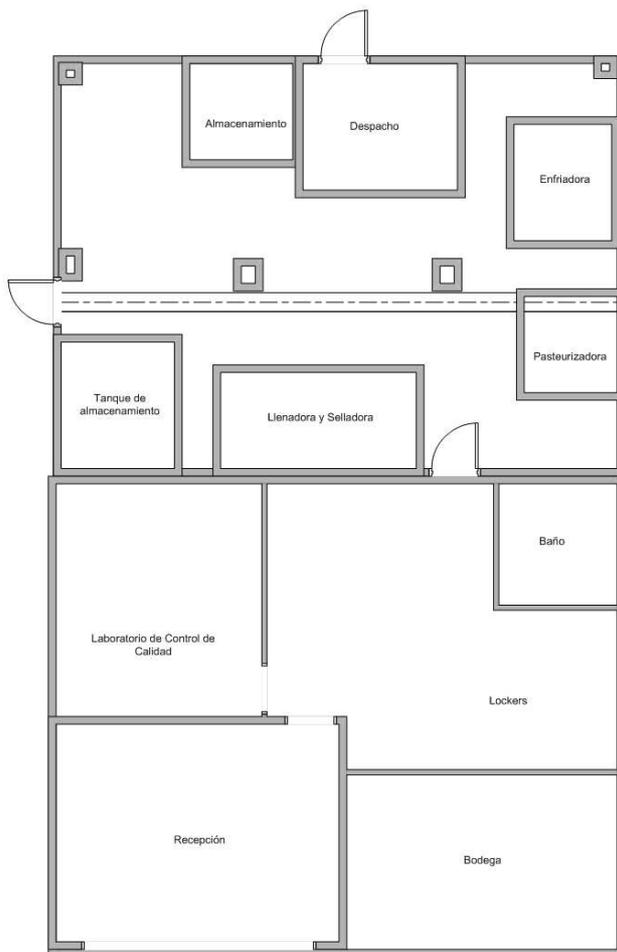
Plano propuesto de la planta de pasteurización de CEDECO.
